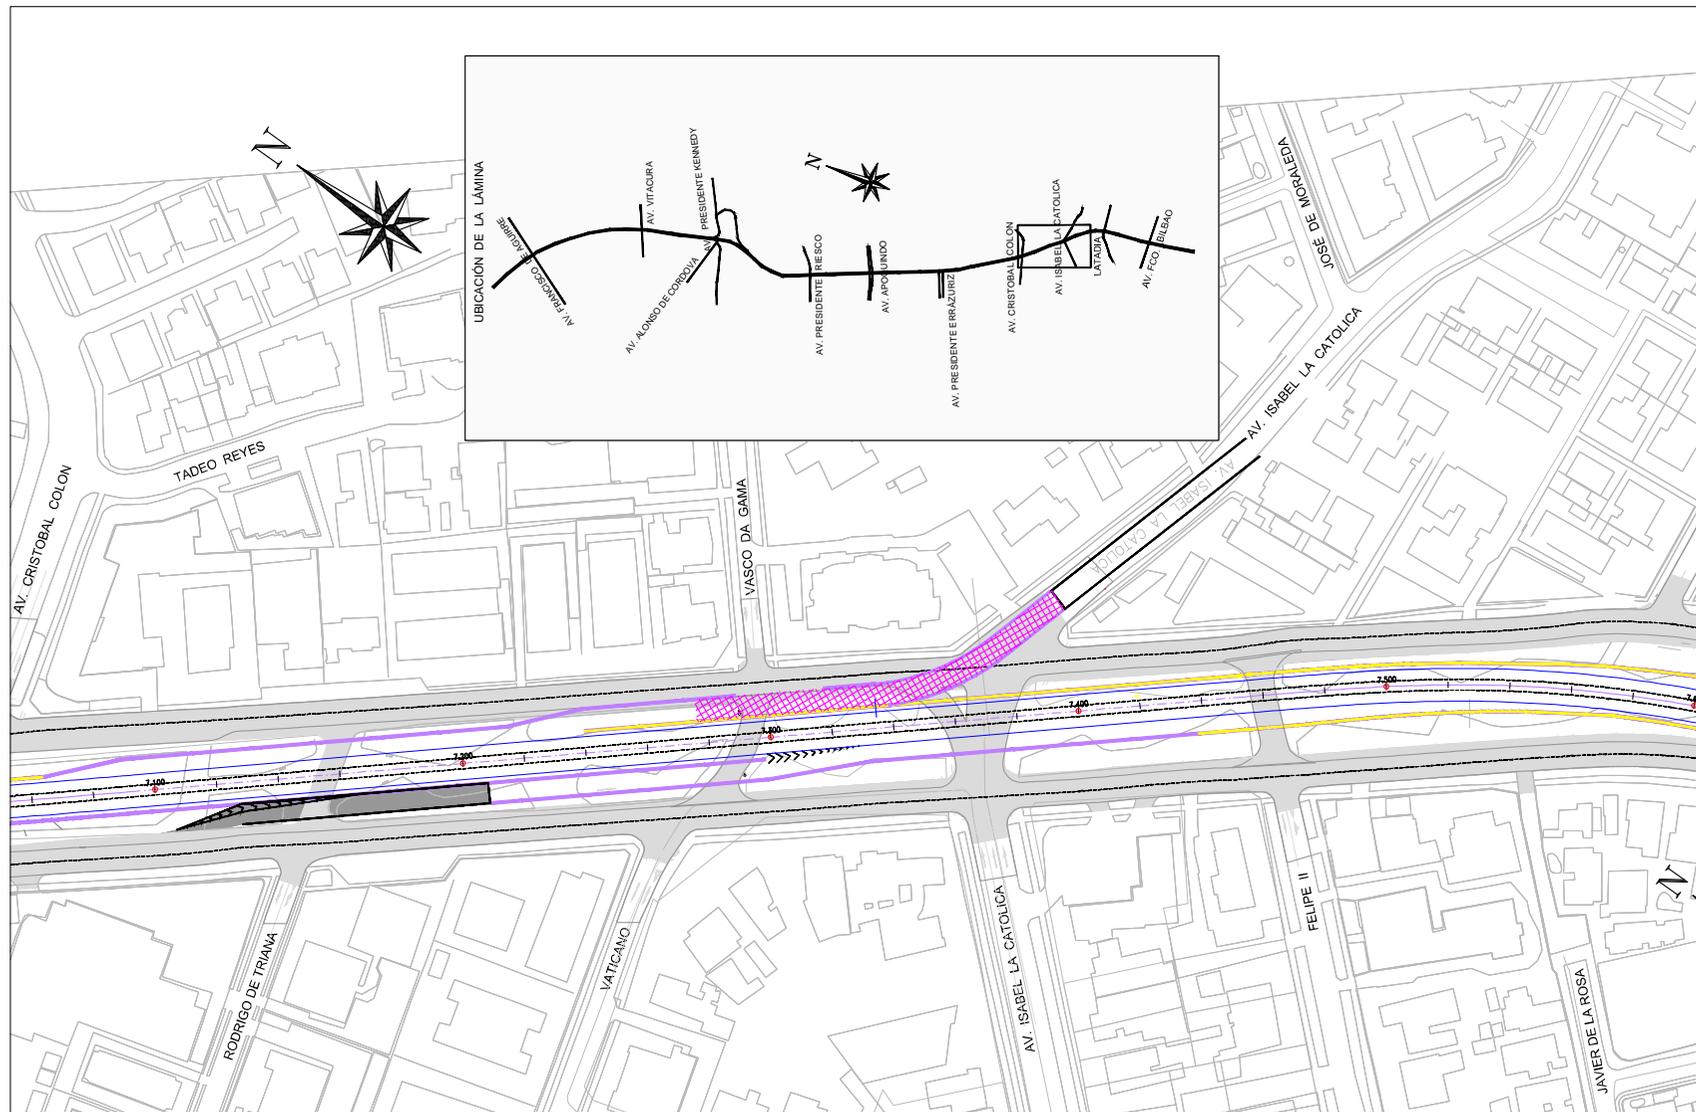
Planta de Túnel Minero Conexión a Isabel La Católica
